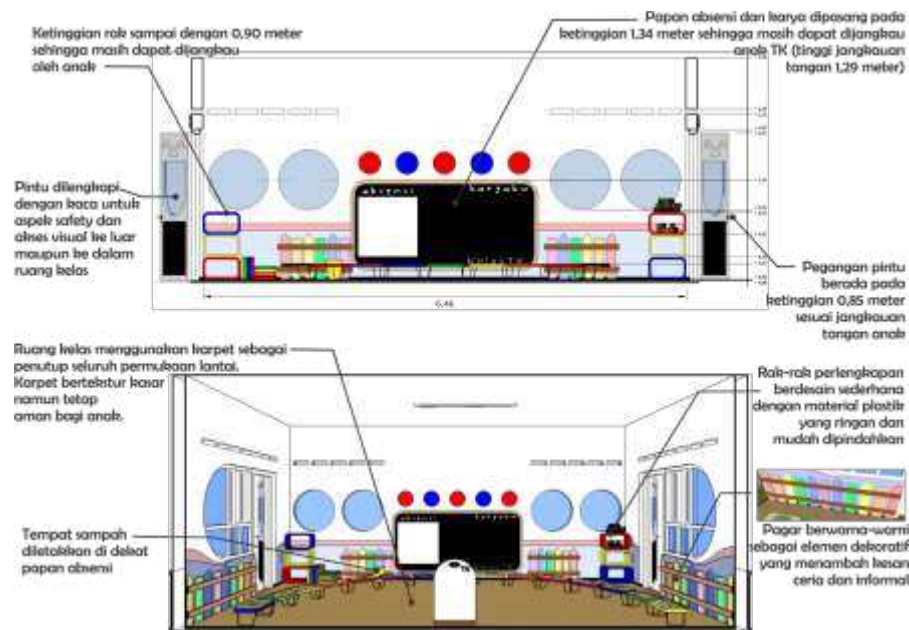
Denah dan Denah Orthogonal Ruang Kelas TK
